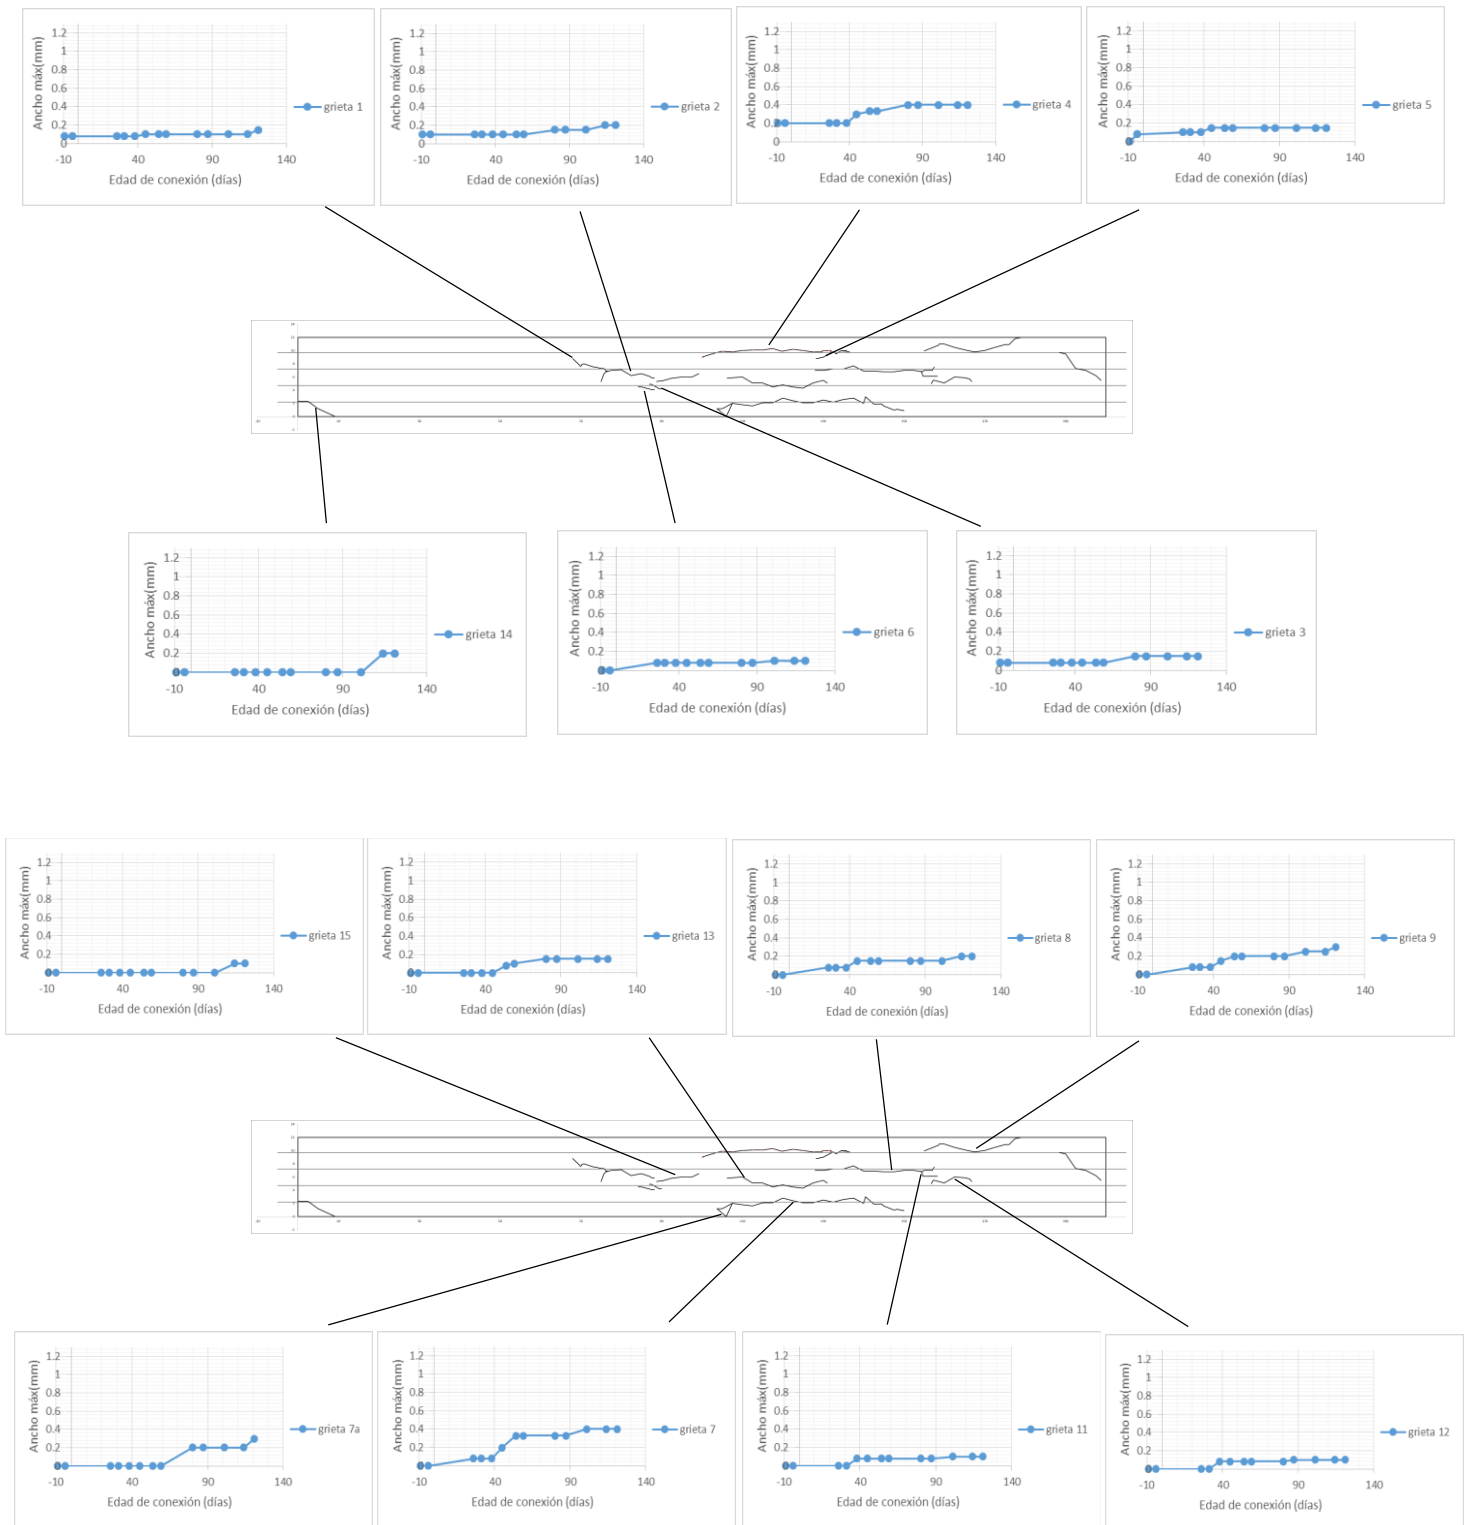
Localización y ancho máximo de grieta viga VCPC5.
